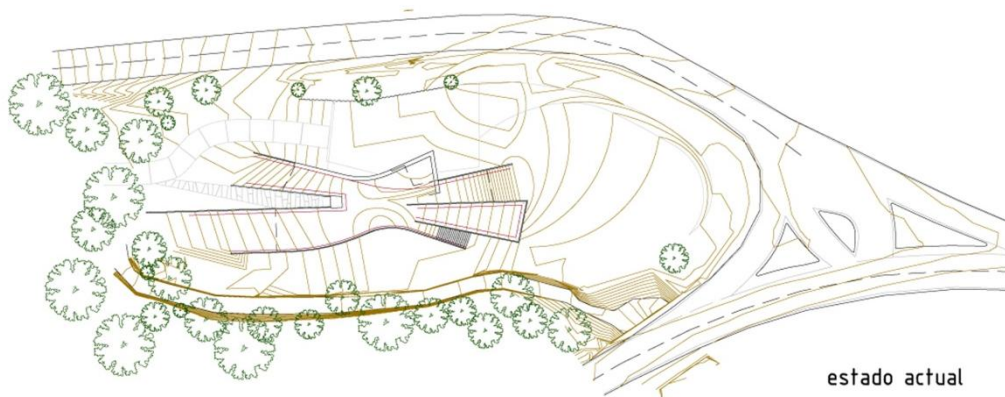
Plano de situación. Fuente: Ficha técnica Premios Construcción Sostenible.
